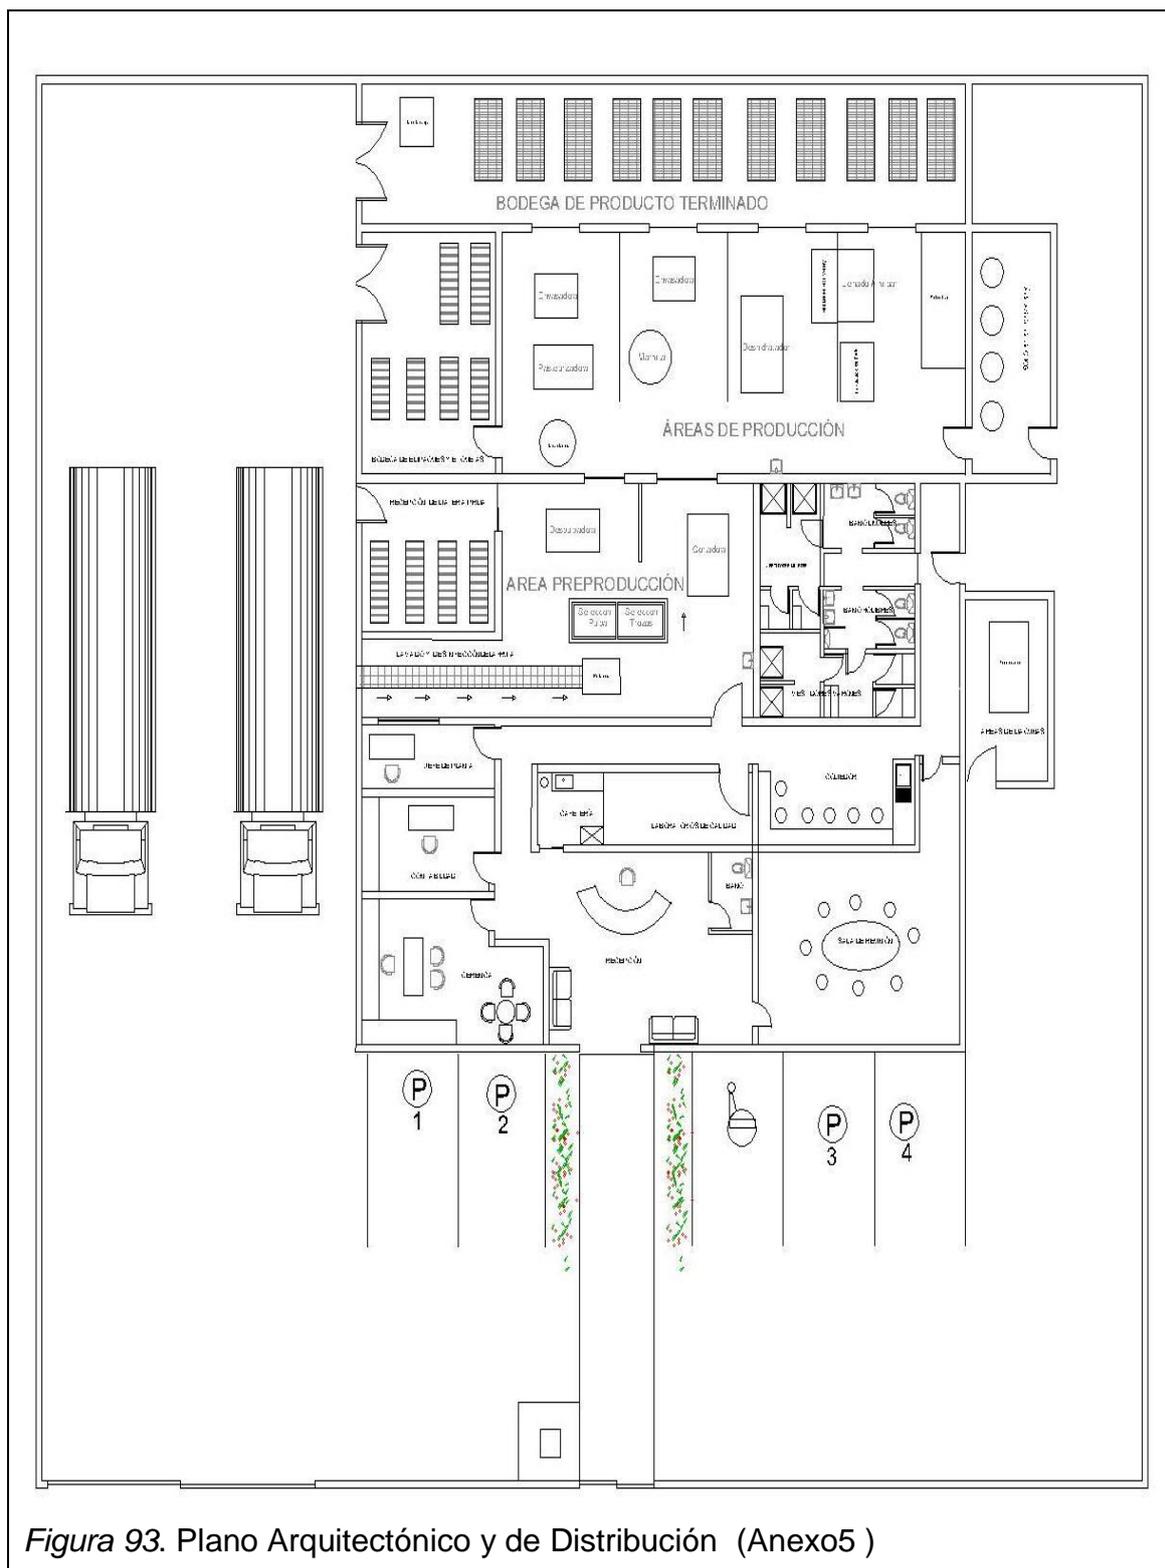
Plano Arquitectónico y de Distribución (Anexo5)
